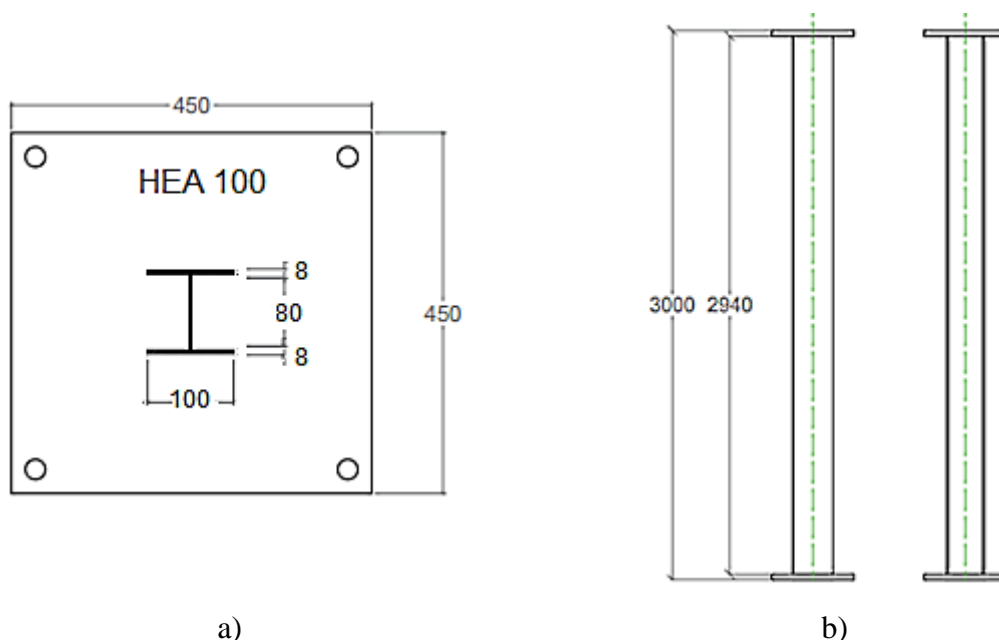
a) Secção transversal do pilar metálico em conjunto com as chapas de topo soldada b) Altura do pilar
